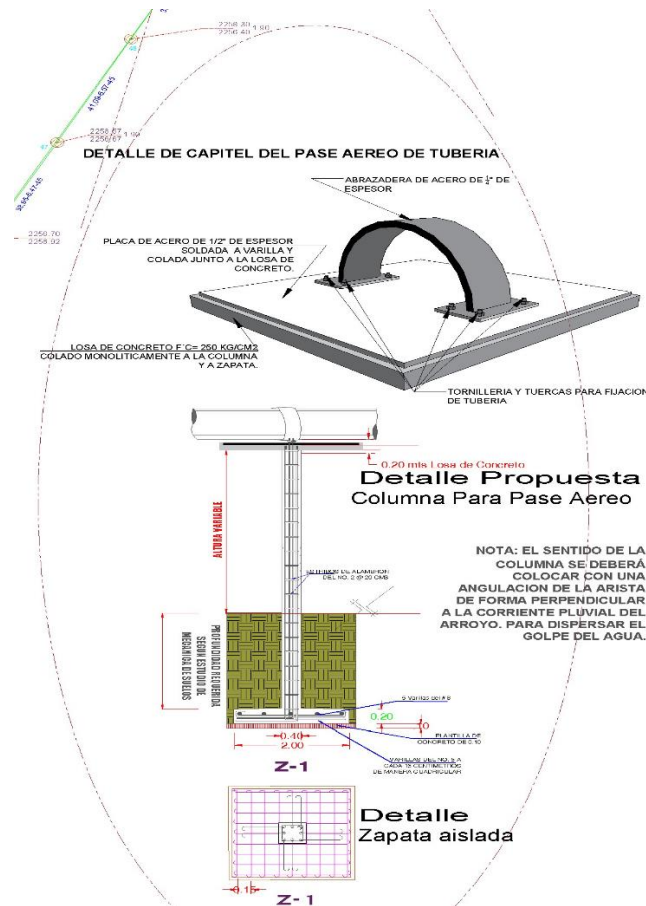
DISEÑO DE CONSTRUCCIÓN DE ZAPATAS
